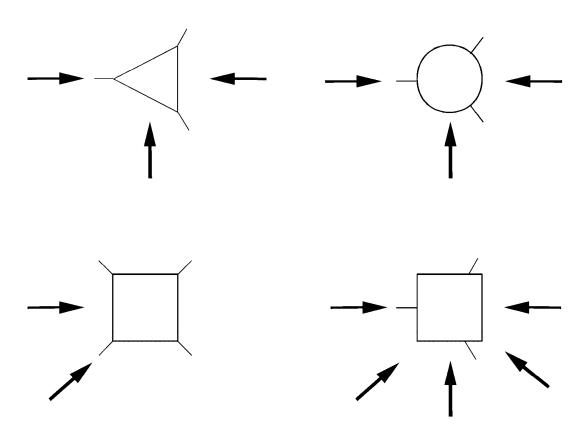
Mindestkräfte in den Schubausfachungen des Mastschaftes
